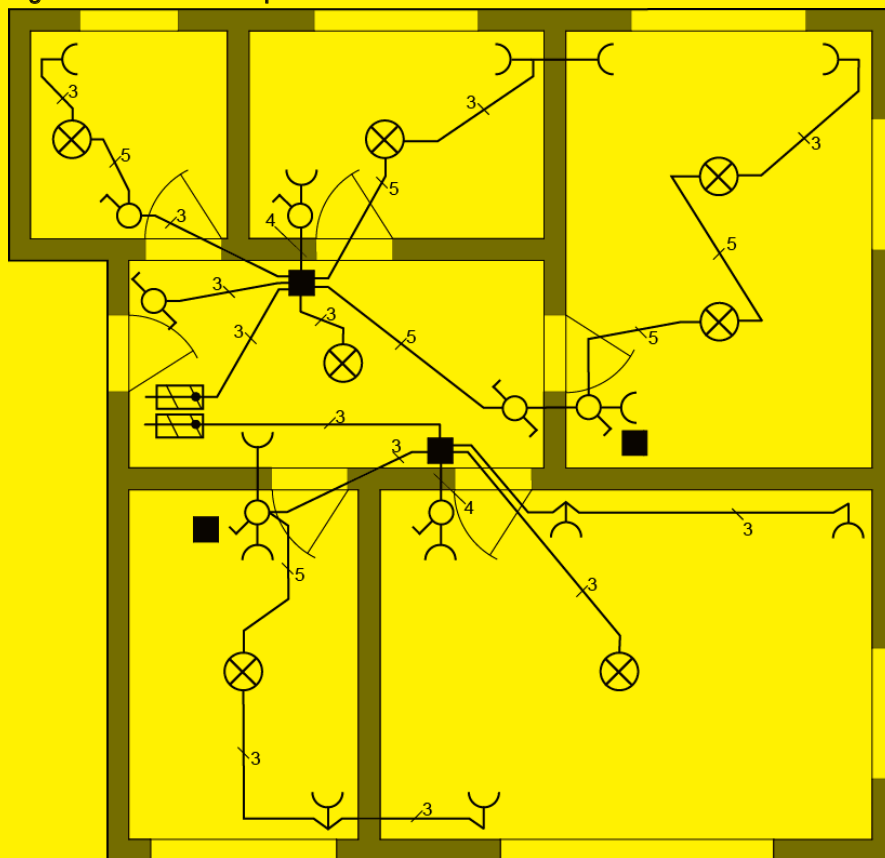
Exemple de schéma d'installation
